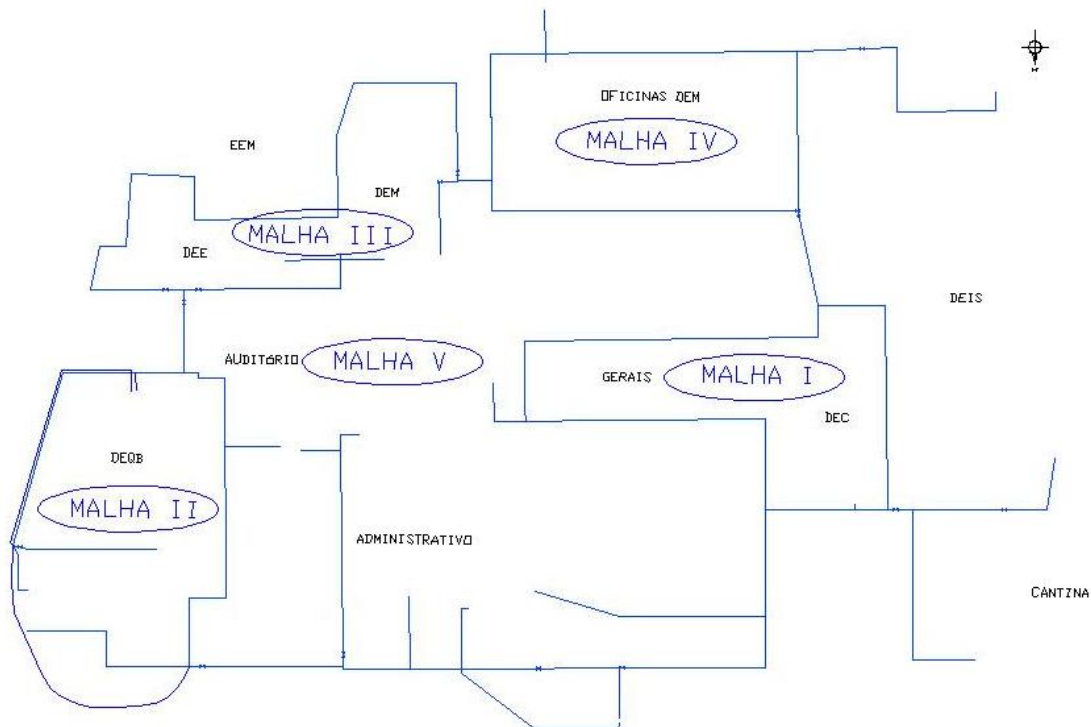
Planta esquemática da rede de distribuição de águas do *campus* do ISEC.
